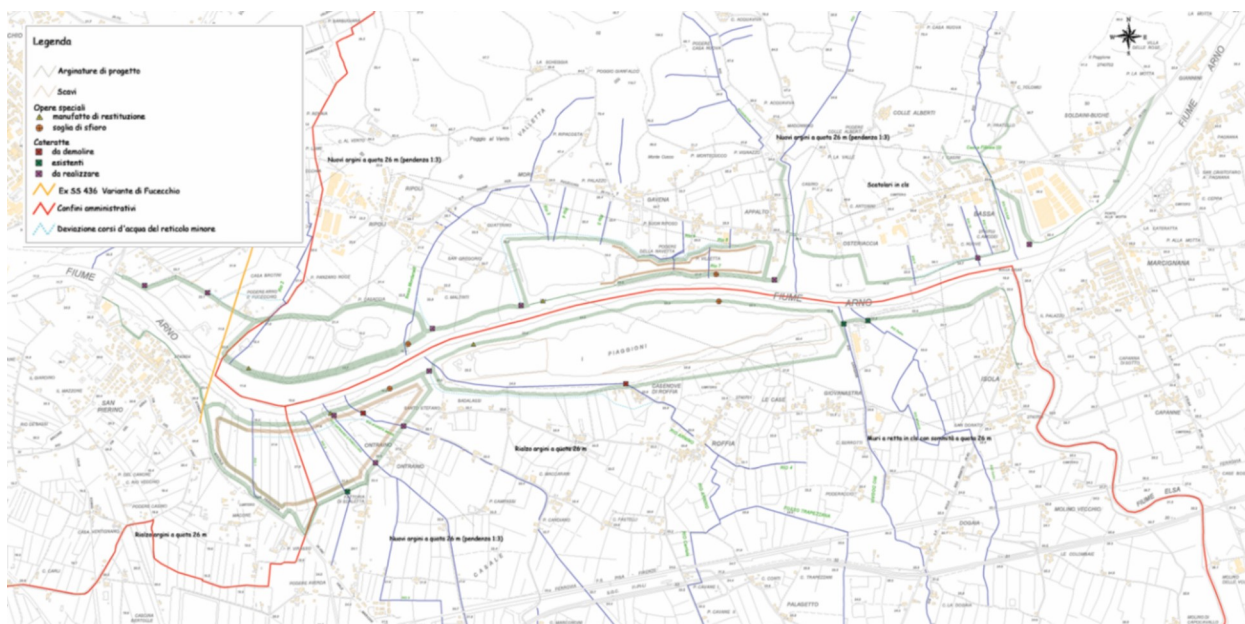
estratto da planimetria progetto preliminare casse di Roffia
